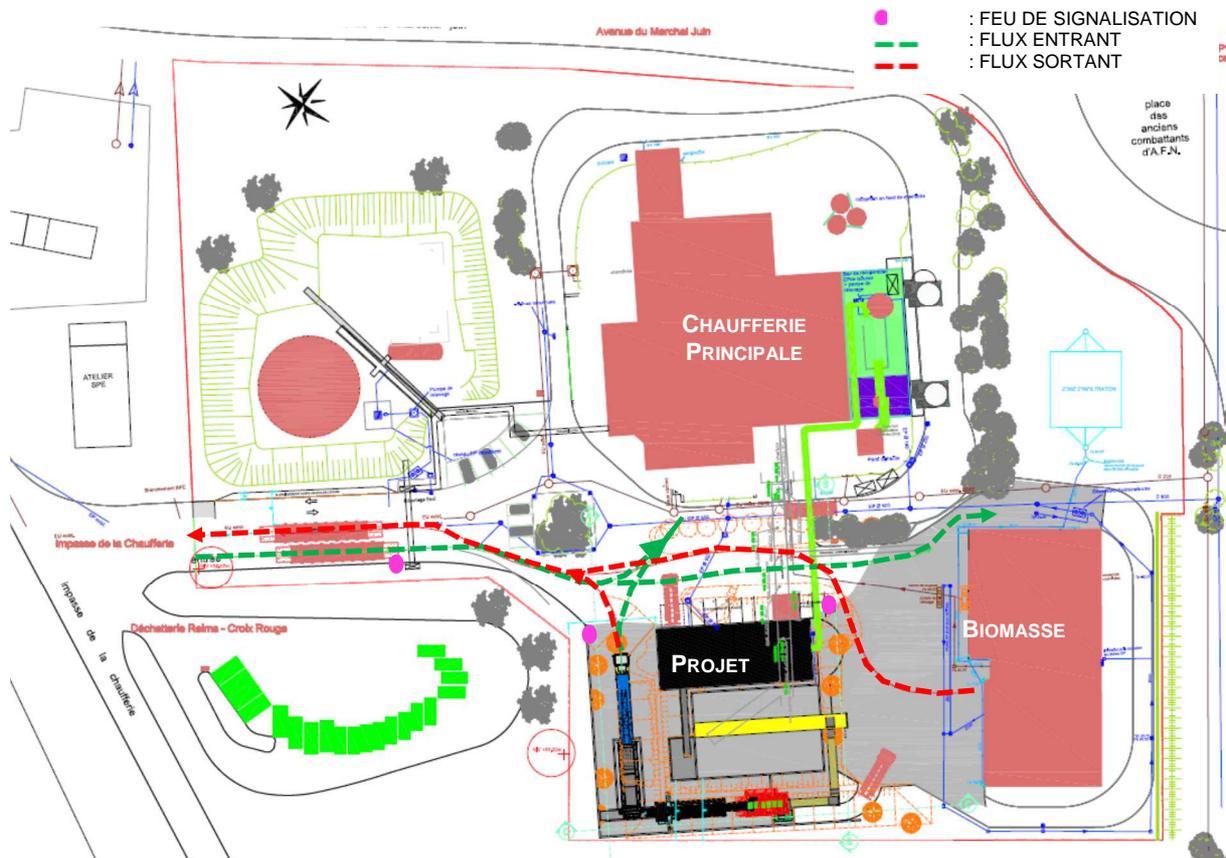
PLAN DE CIRCULATION INTERNE AU SITE – VARIANTE N°1
